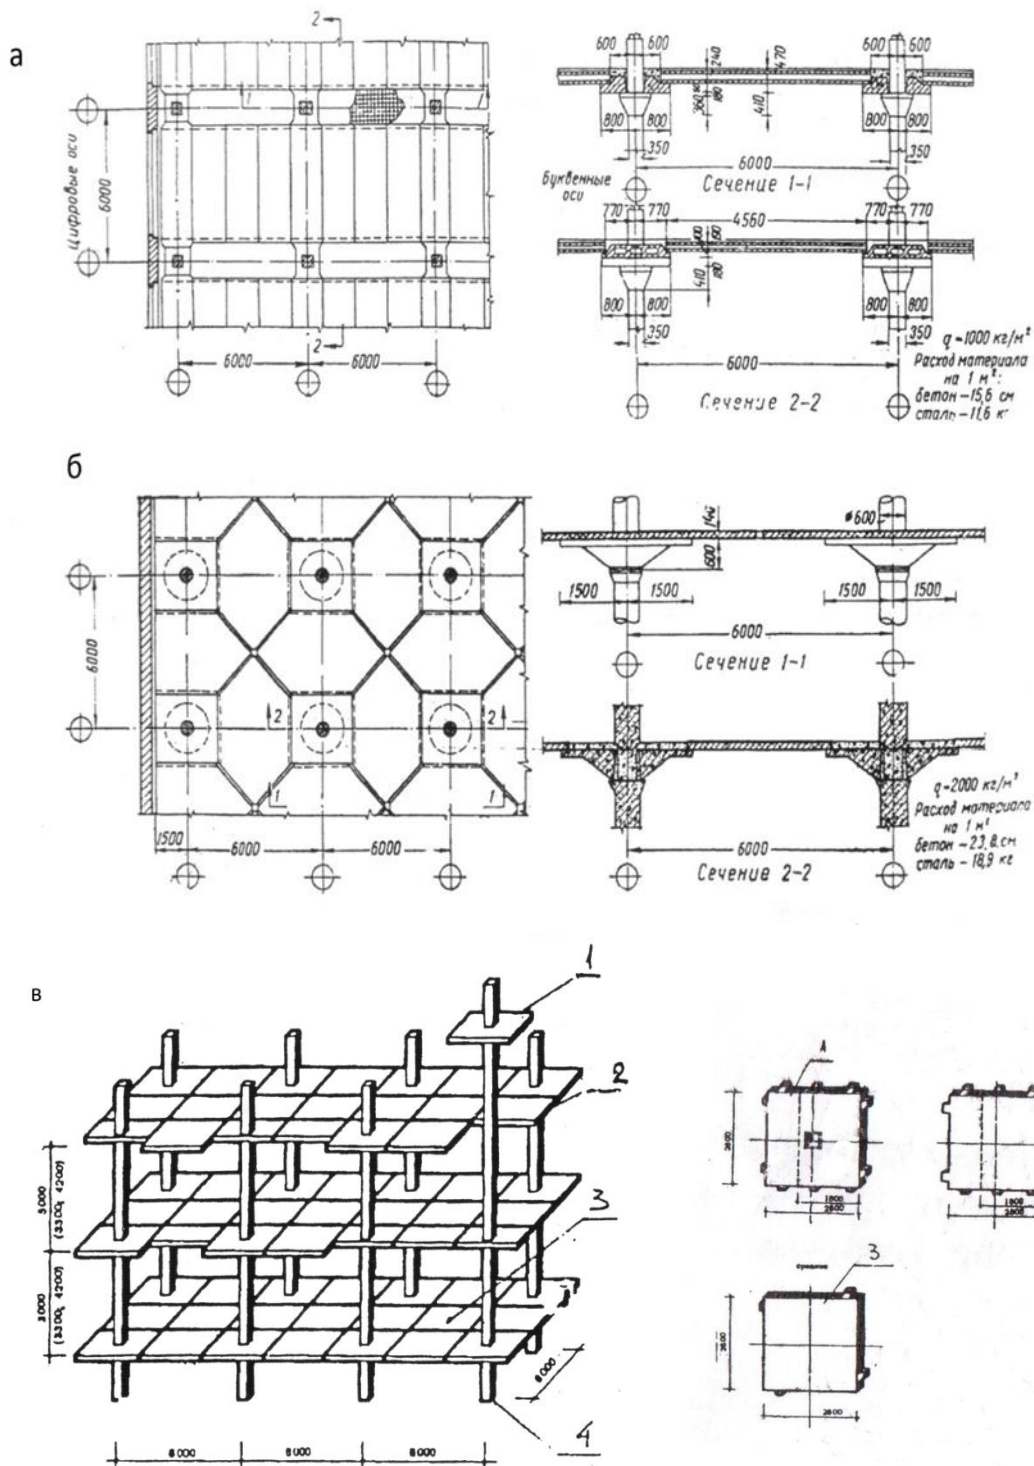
Безригельный каркас с сеткой колонн 6х6 м: а - безбалочное перекрытие с надколонными плитами одного направления; б - то же, с межколонными плитами; в - безбалочное перекрытие системы «куб»
